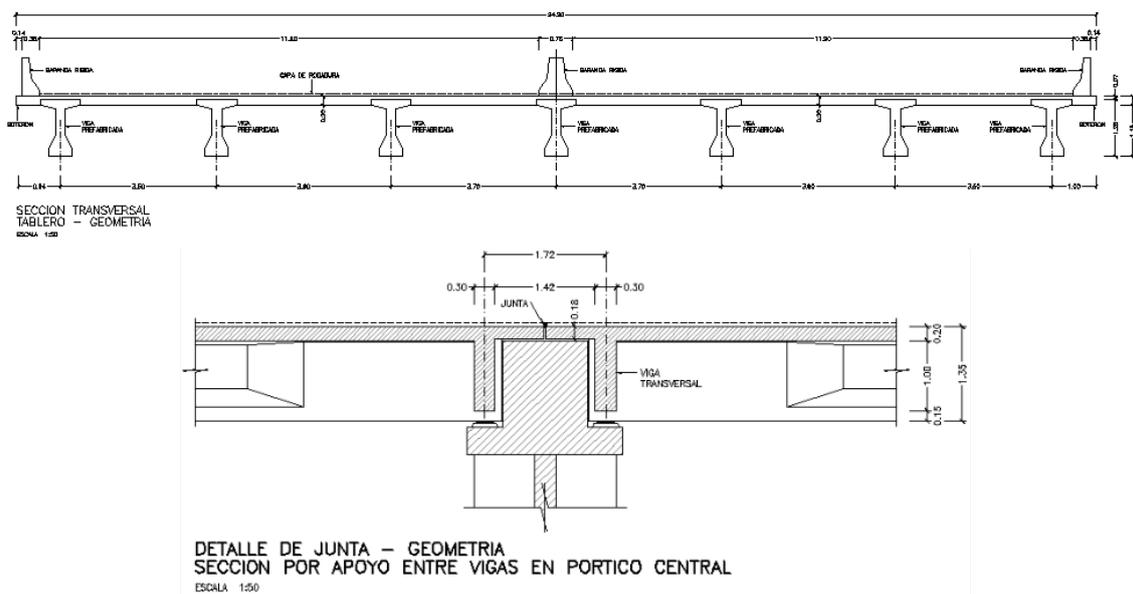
Vigas longitudinales y apoyo en pórtico
